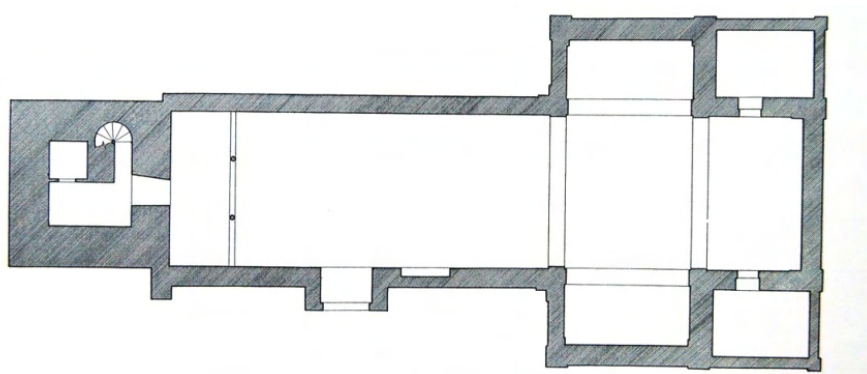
Planta de M. T. Sánchez Trujillano⁸⁹. 2002.
